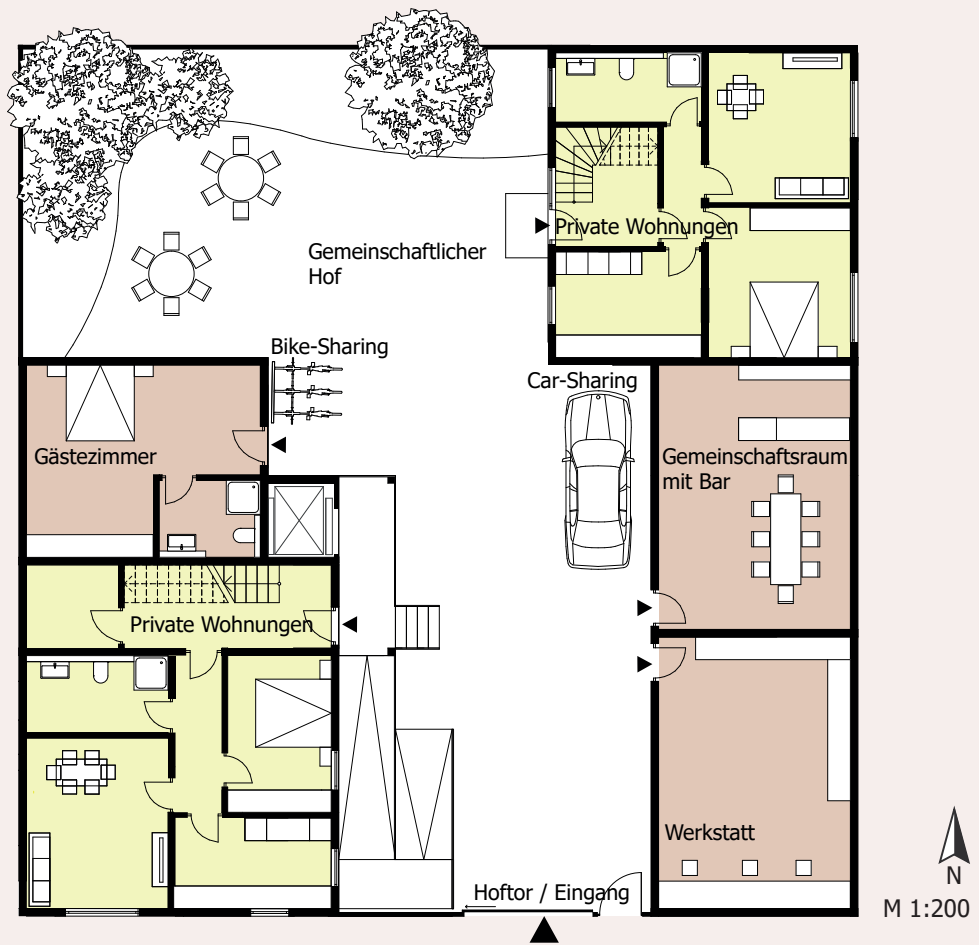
Beispiel Grundriss eines gemeinschaftlich genutzten Gehöfts
